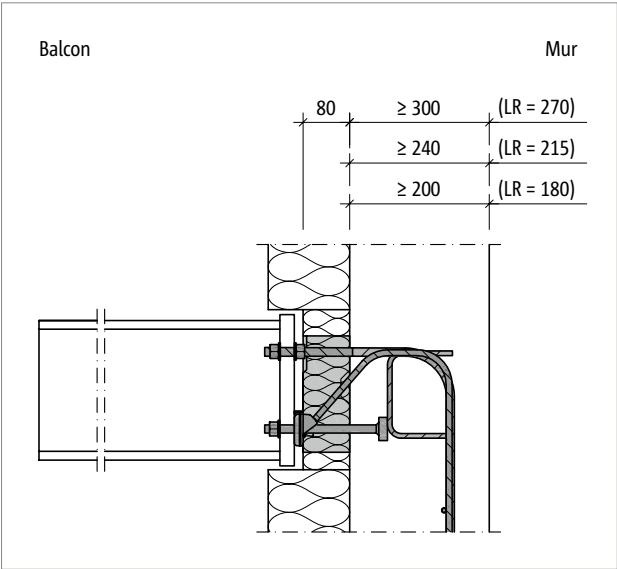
Schöck Isokorb® T type SK-WU : construction spéciale pour raccord mural
